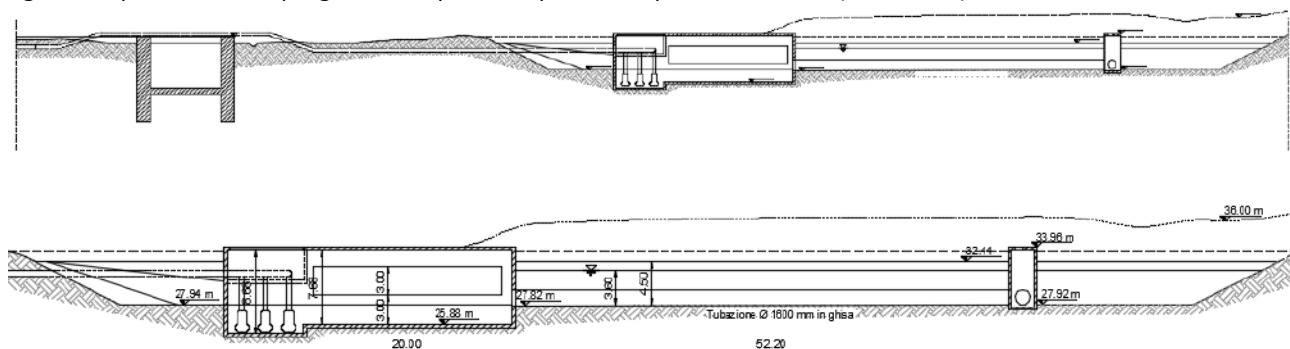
Sezione del passaggio sopra alla ferrovia con dettaglio della vasca di laminazione e della precamera
